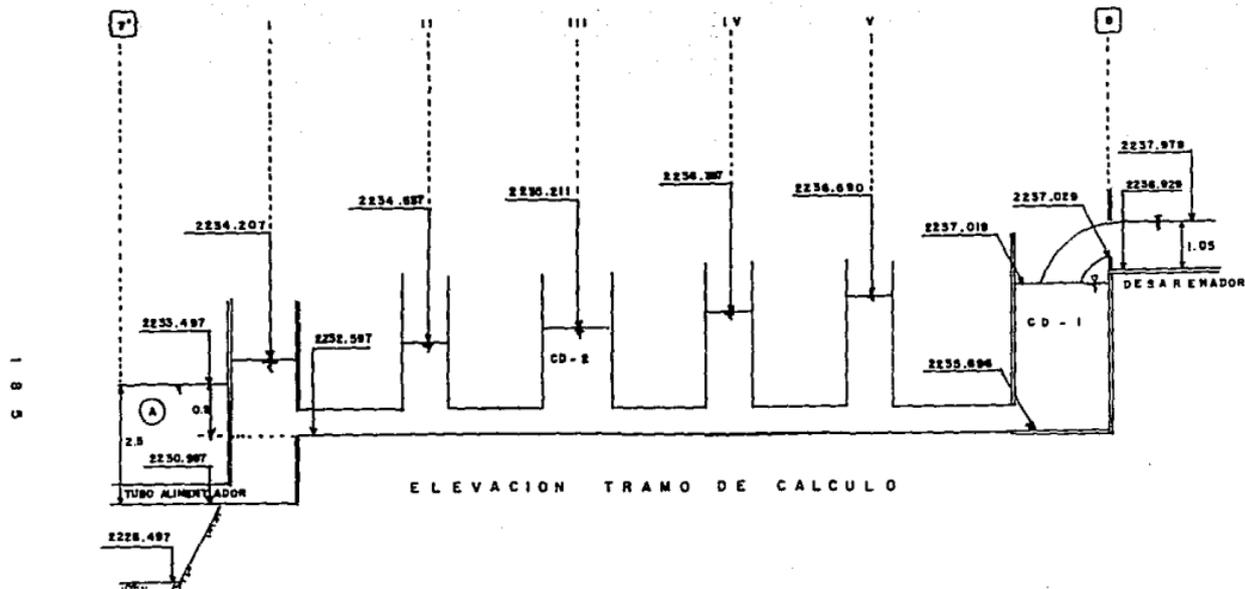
(b) TRAMO 7' - 8 "ELEVACION"
